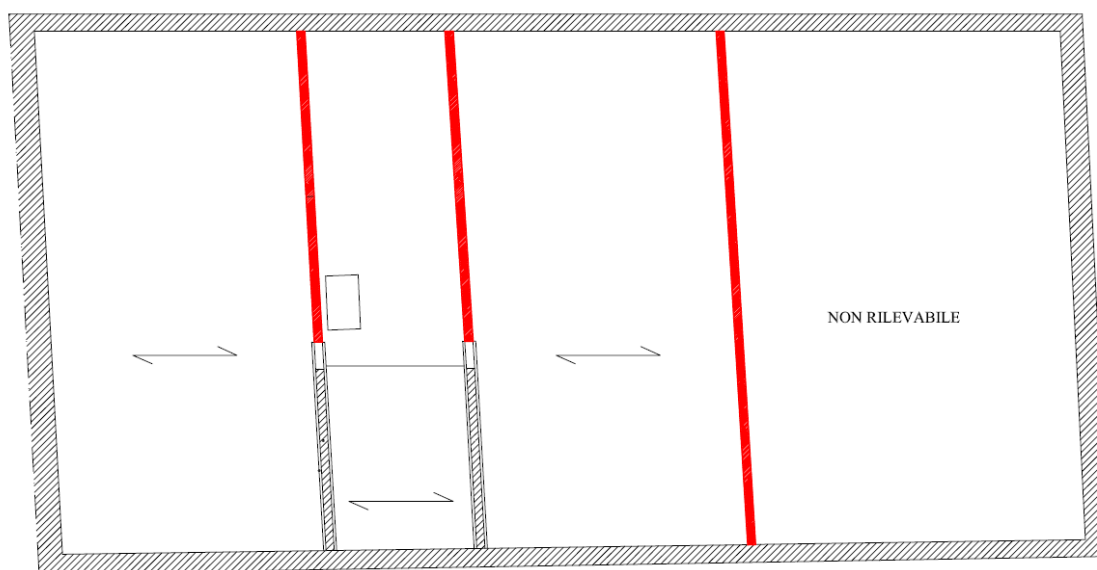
Pareti del sottotetto su cui realizzare l'intonaco armato
